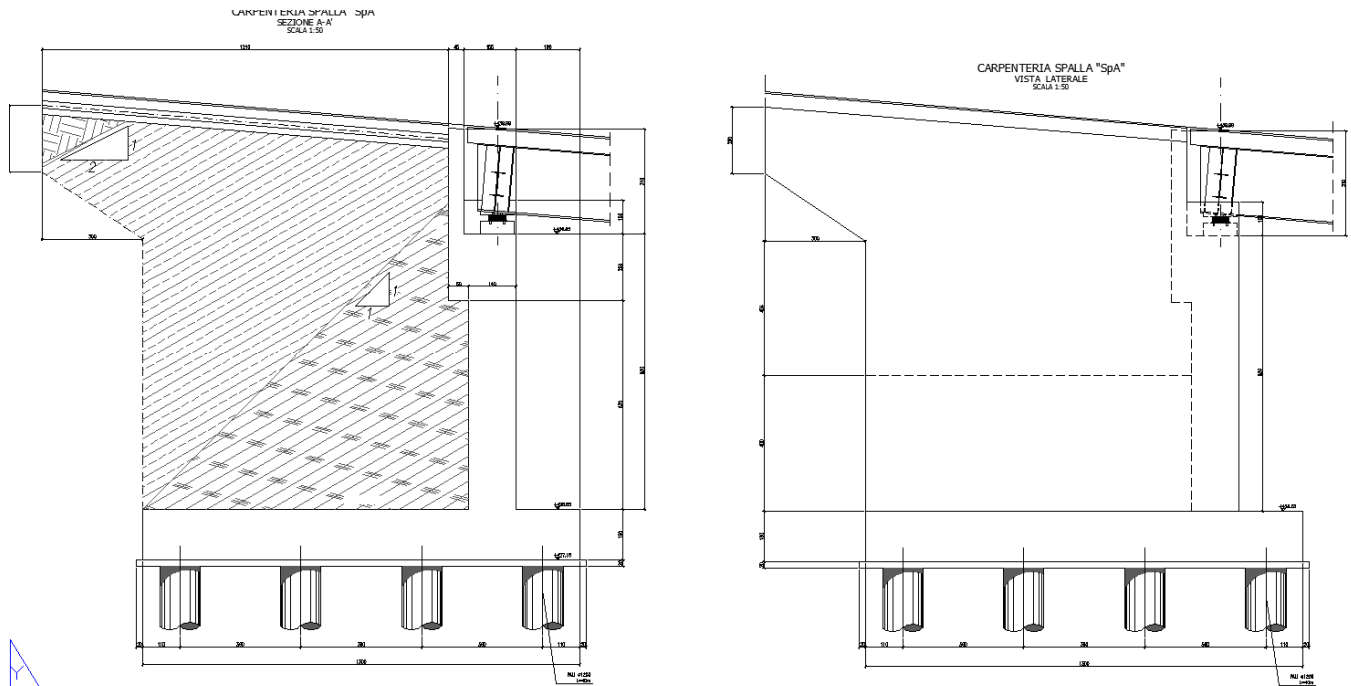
Sezione e vista longitudinale spalla A.
